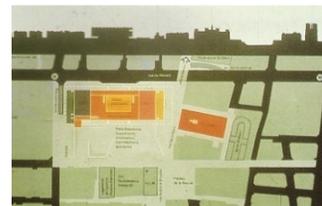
Planta de implantação: Centro Pompidou e IRCAM.
